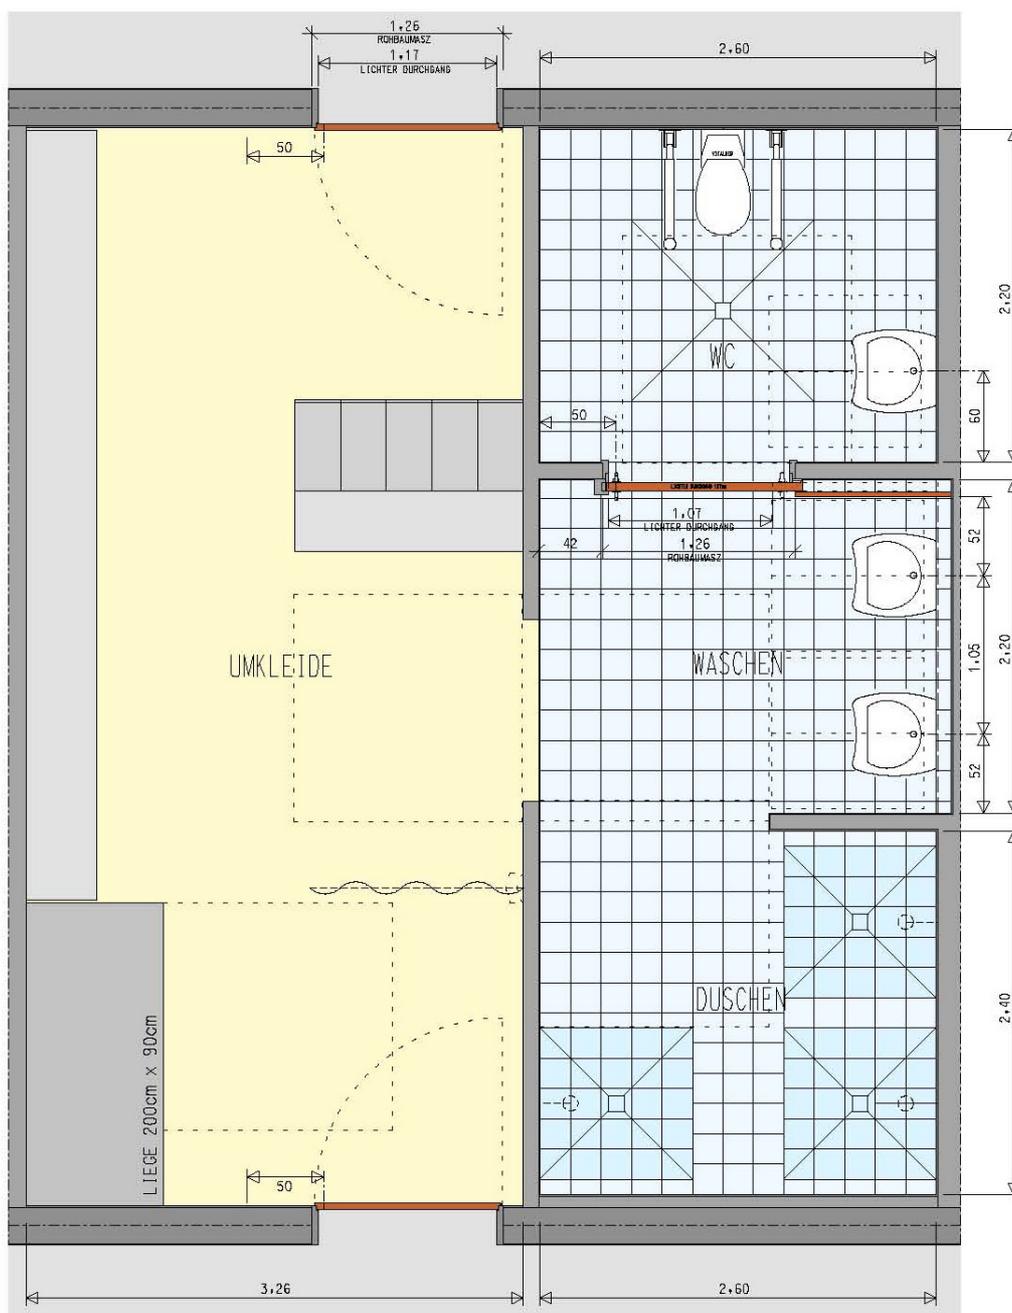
Beispiel: Zweifach / Dreifach-Sporthalle nach DIN 18032-1 und DIN 18040-1 mit halber Raumeinheit Umkleide und Sanitärblock (Dipl.-Ing. M. Bruckner).
